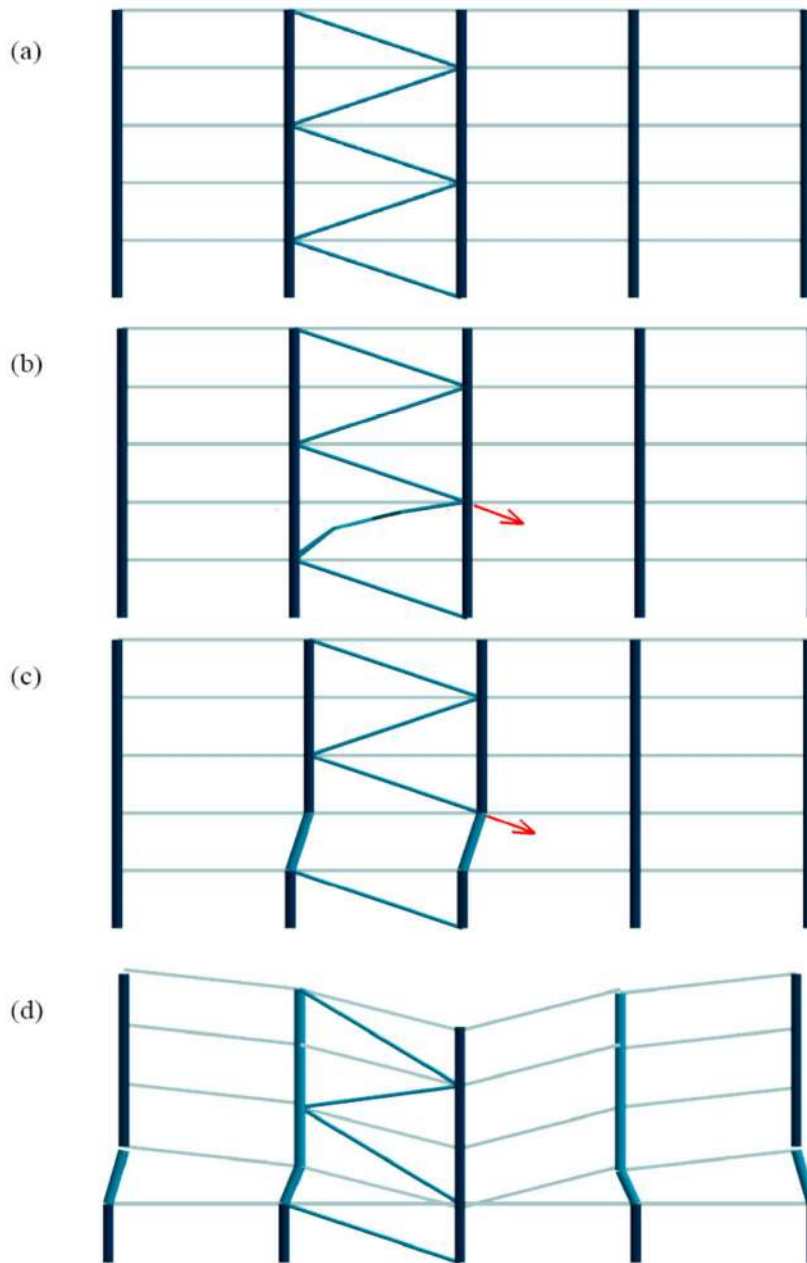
Evolução do colapso progressivo tipo instabilidade: a) estrutura original com sistema de contraventamento; b) falha inicial no contraventamento; c) perda de estabilidade da estrutura; d) colapso (KOZLOVA, 2013)
